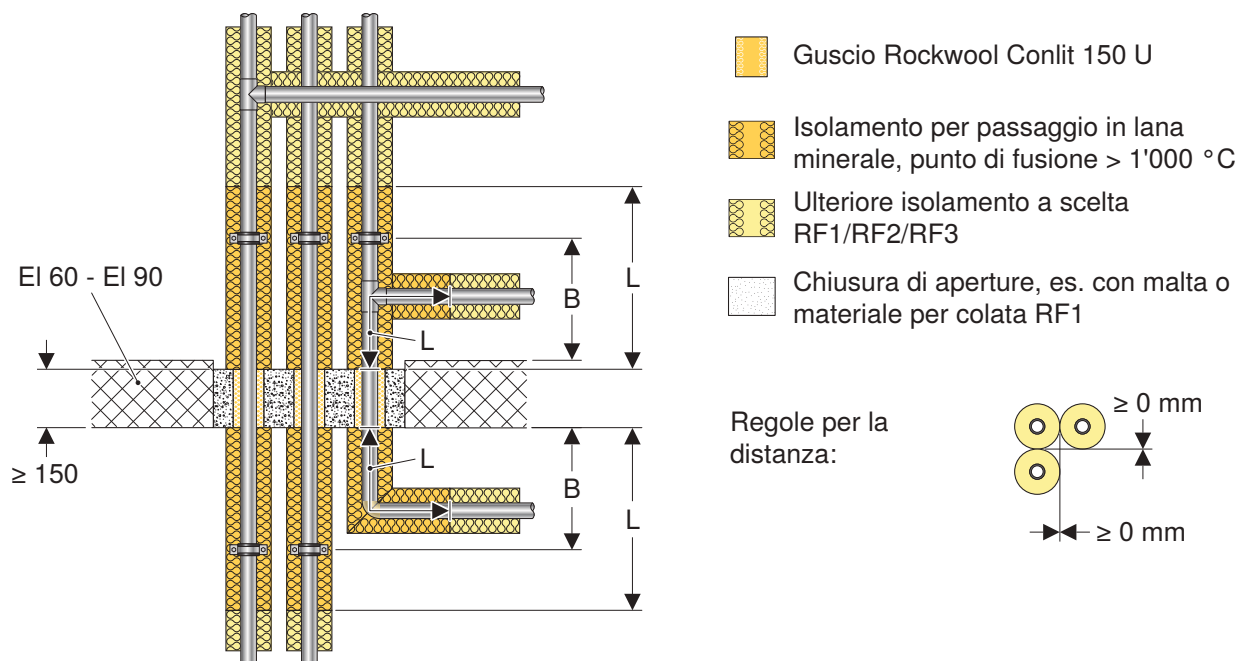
Attraversamento di soffitto con isolamento Rockwool 800
